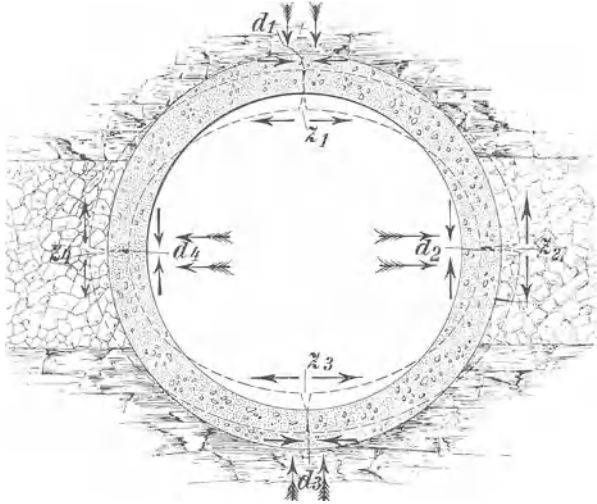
Schematische Darstellung eines Betongewölbes mit Biegebeanspruchung.
